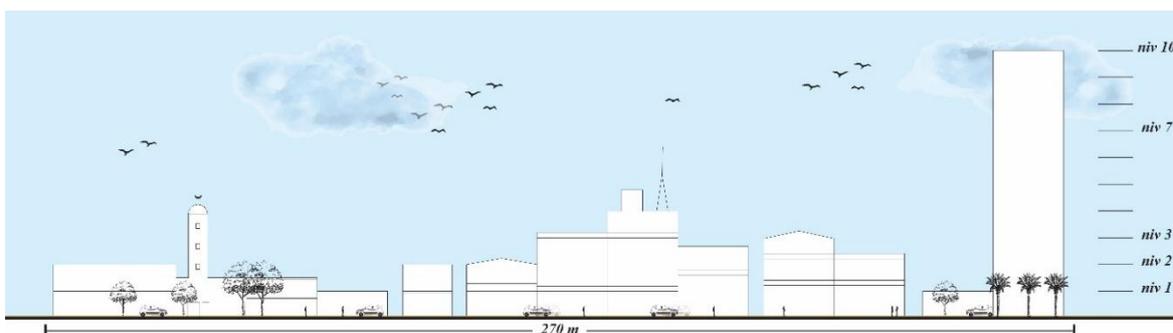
Une illustration montrant la façade Nord-ouest [Route Yousfi Abdelkader] en face du site. Source : Auteurs, 2025.
